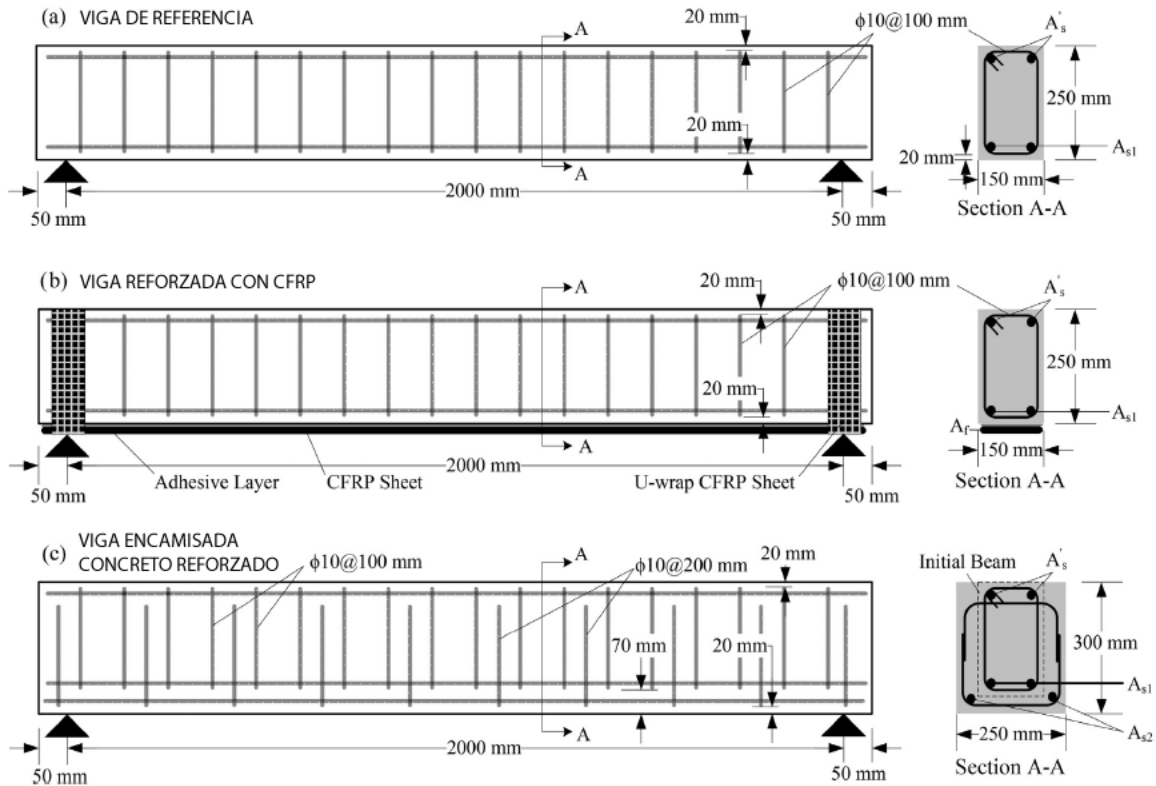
Dimensiones y configuración del refuerzo en las vigas.
